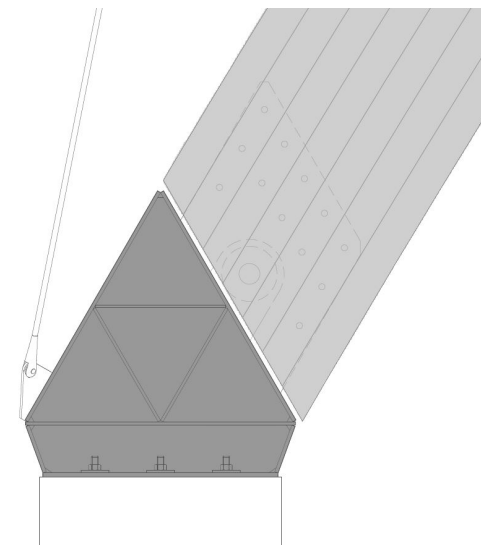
Detalle del encuentro de uno de los arcos individuales con un pilar de hormigón prefabricado de la bodega protos. (Fuente: Elaboración propia a partir de la documentación facilitada por Rosa Bellido Pla).
